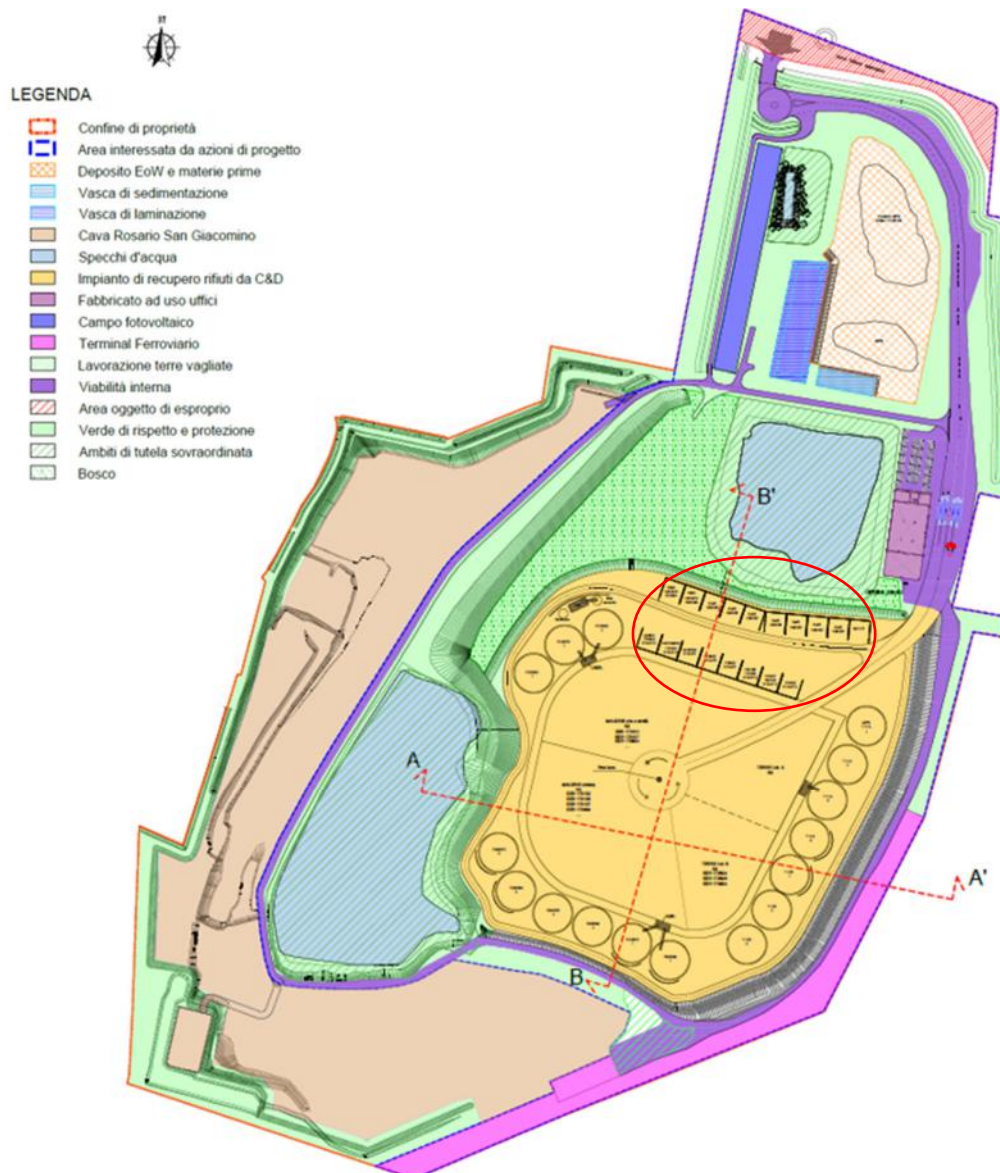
Individuazione zona box prefabbricati/misto cementato (stralcio Tav. PF-T11)
